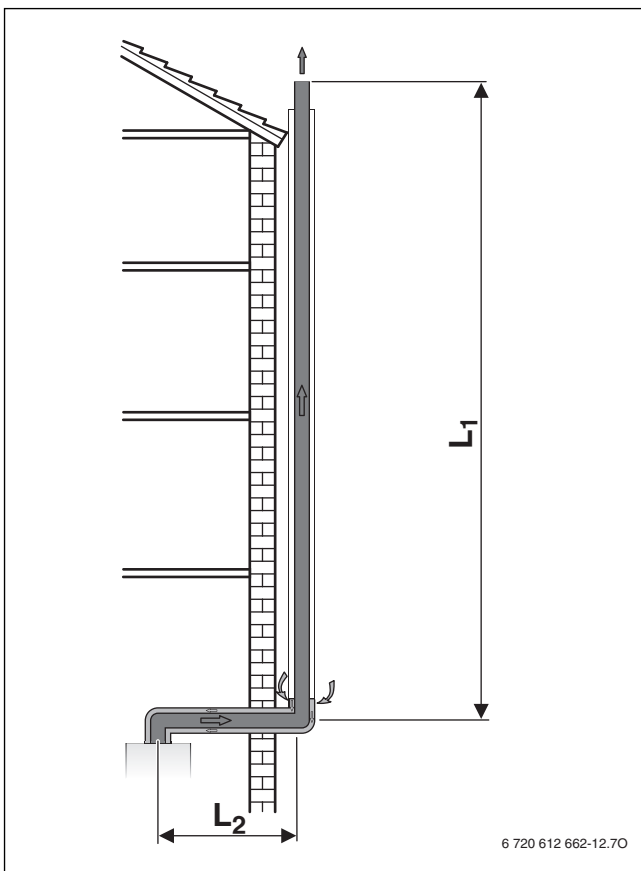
Abgasführung an der Fassade nach C<sub>53x</sub>
